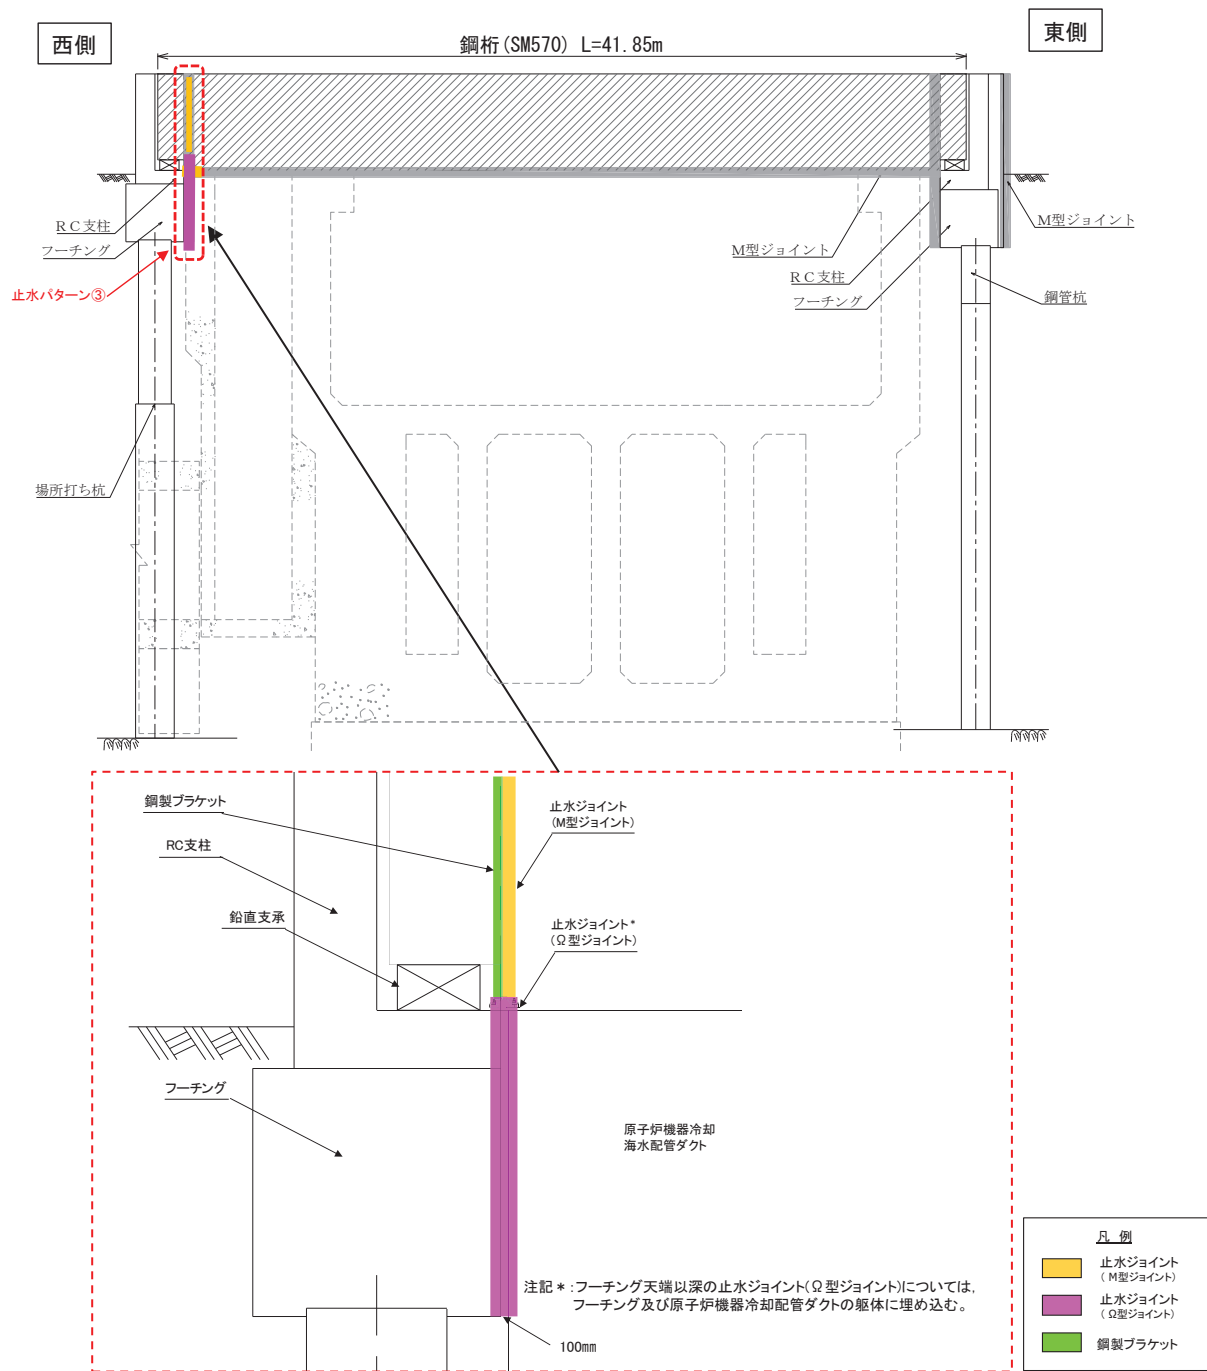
(4) 止水パターン③の構造概要(正面図)
